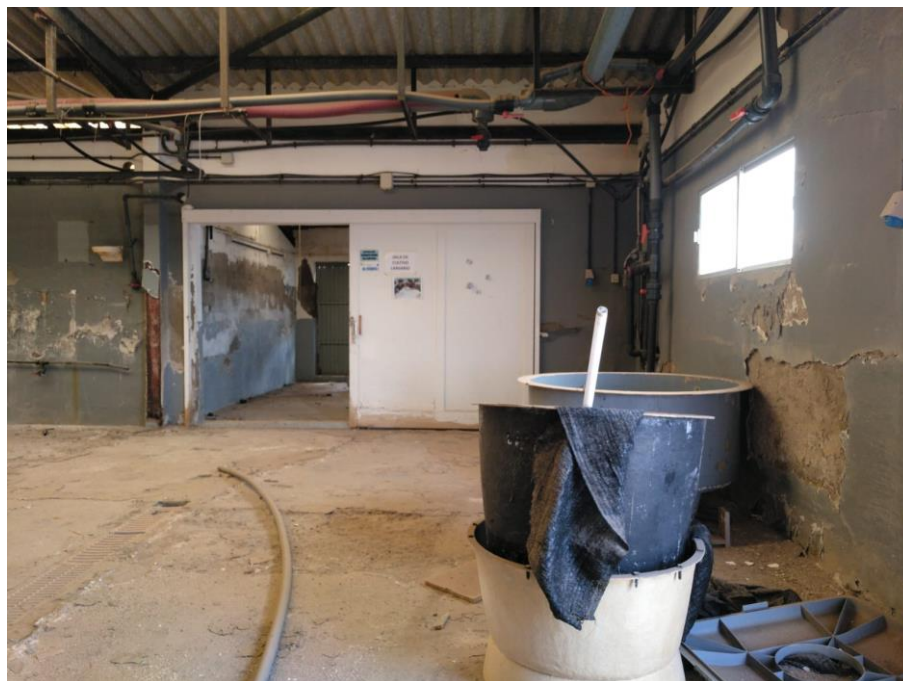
Residuos planta baja nave y tuberías de servicios
